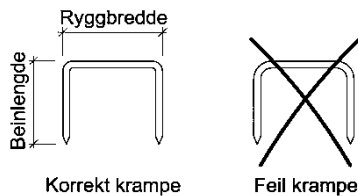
Krampene skal ha rette vinkler mellom rygg og bein
